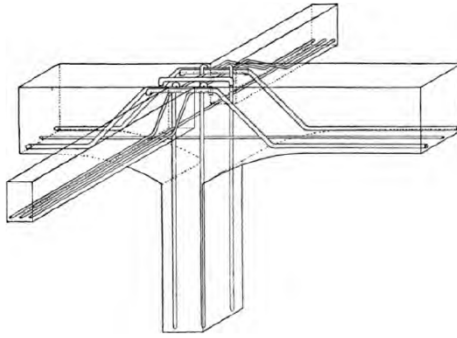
Viga em concreto armado do sistema Monier, 1867. FONTE: <http://engineersoutlook.blogspot.com.br/2011/10/structural-concrete-design.html>
